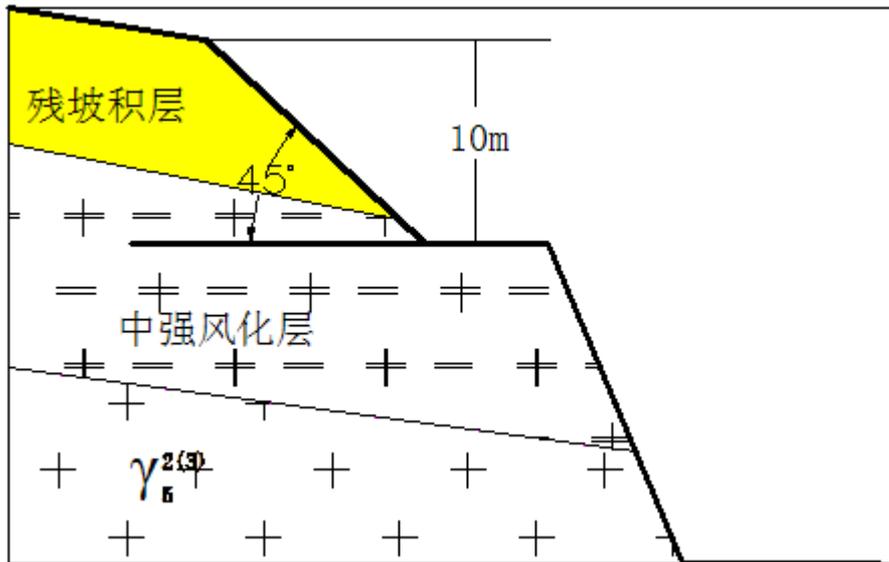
露天采场典型土质边坡 (单台阶) 地质剖面图
